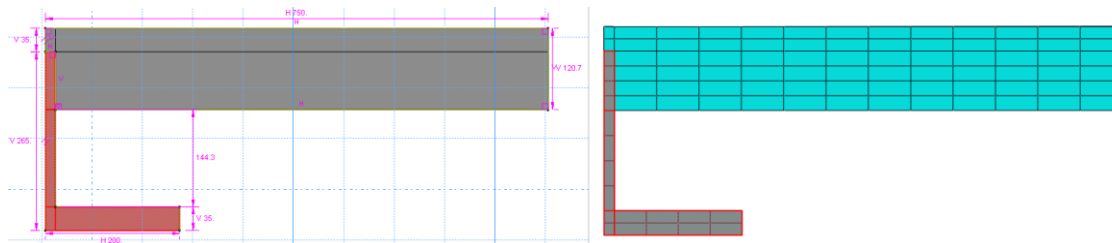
Sketch da viga mista ITB do pavimento com 30cm de espessura e respetiva malha de elementos finitos.
